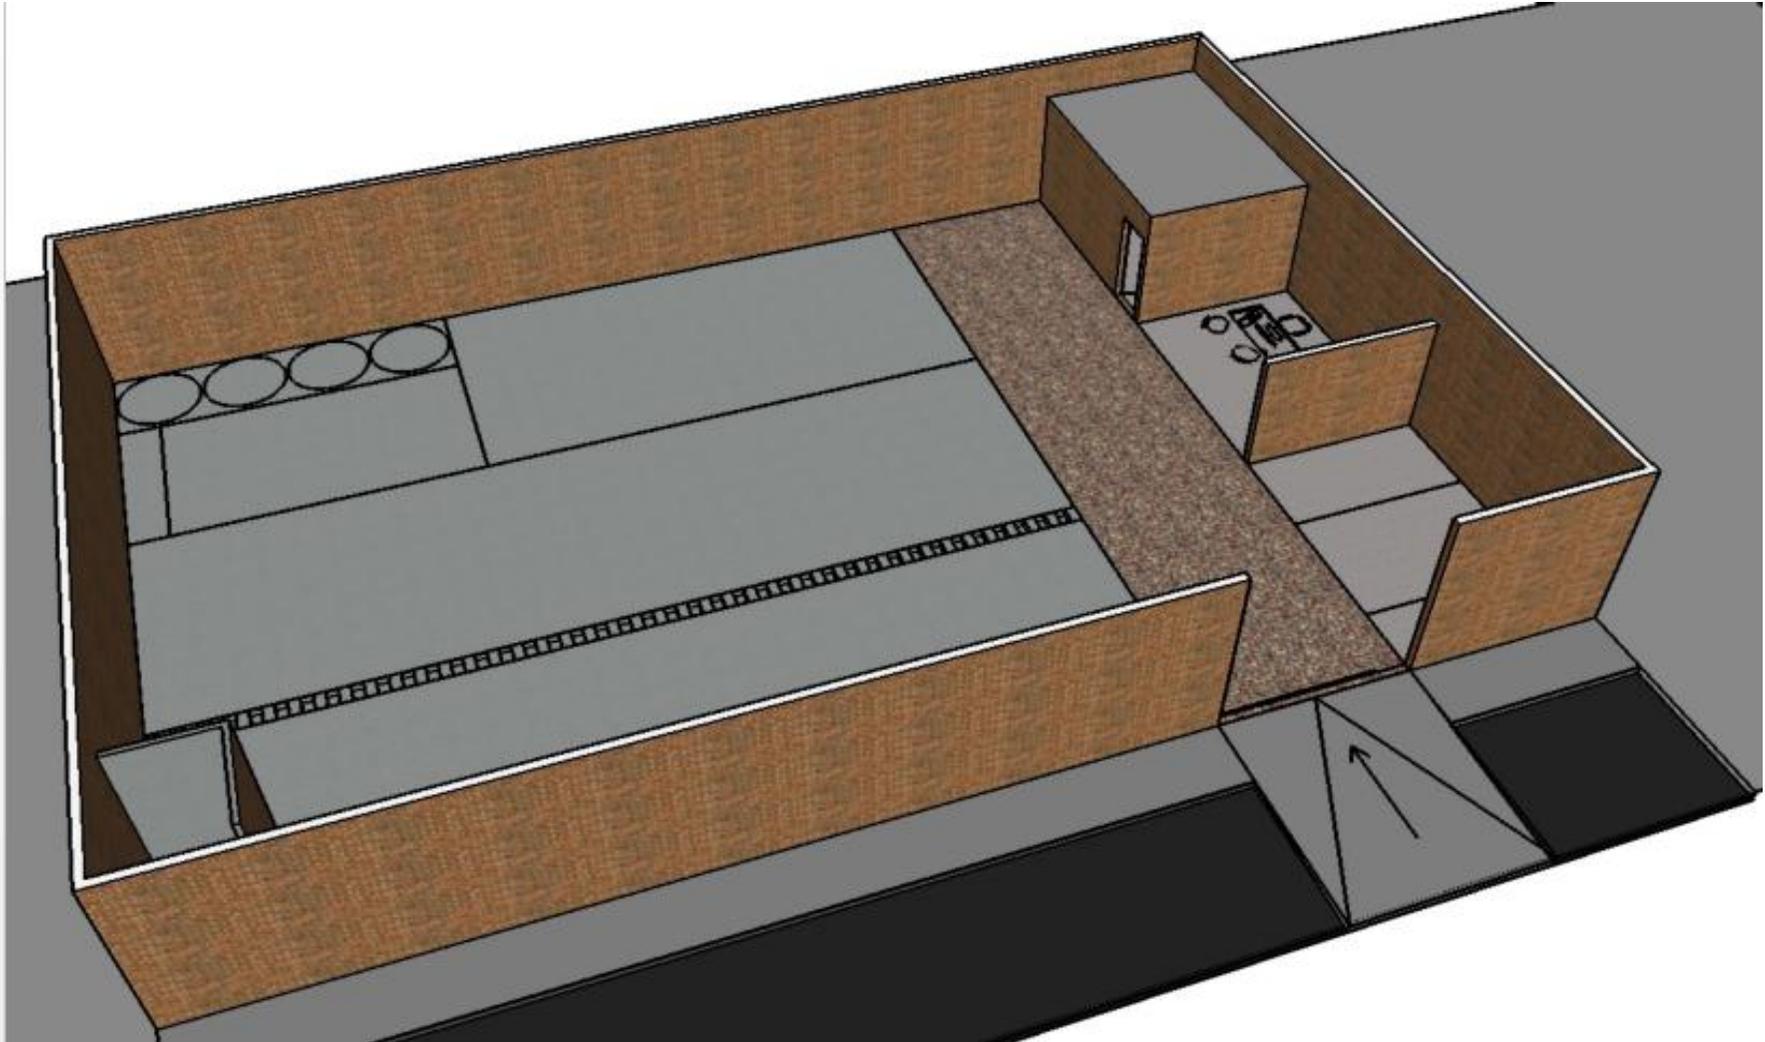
Plano 3D de la empresa Platinum Auto Spa S.R.L, 2017
